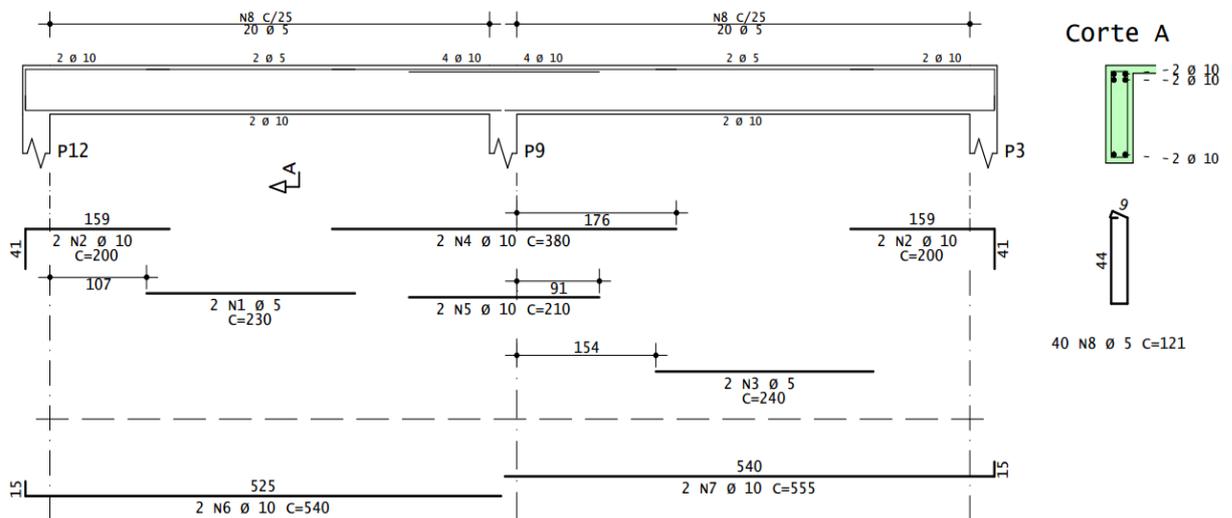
Armadura da viga V9 – coberta (nível +6,00)
